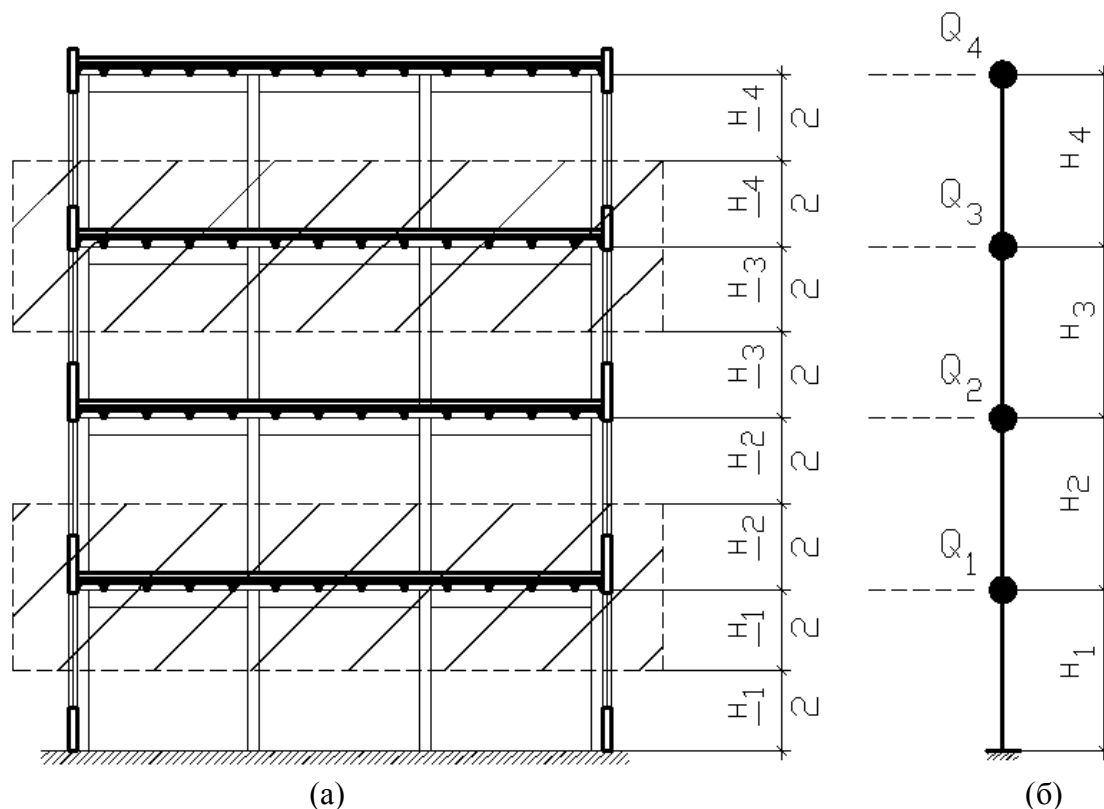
Формирование динамической расчетной схемы каркаса многоэтажного здания:
